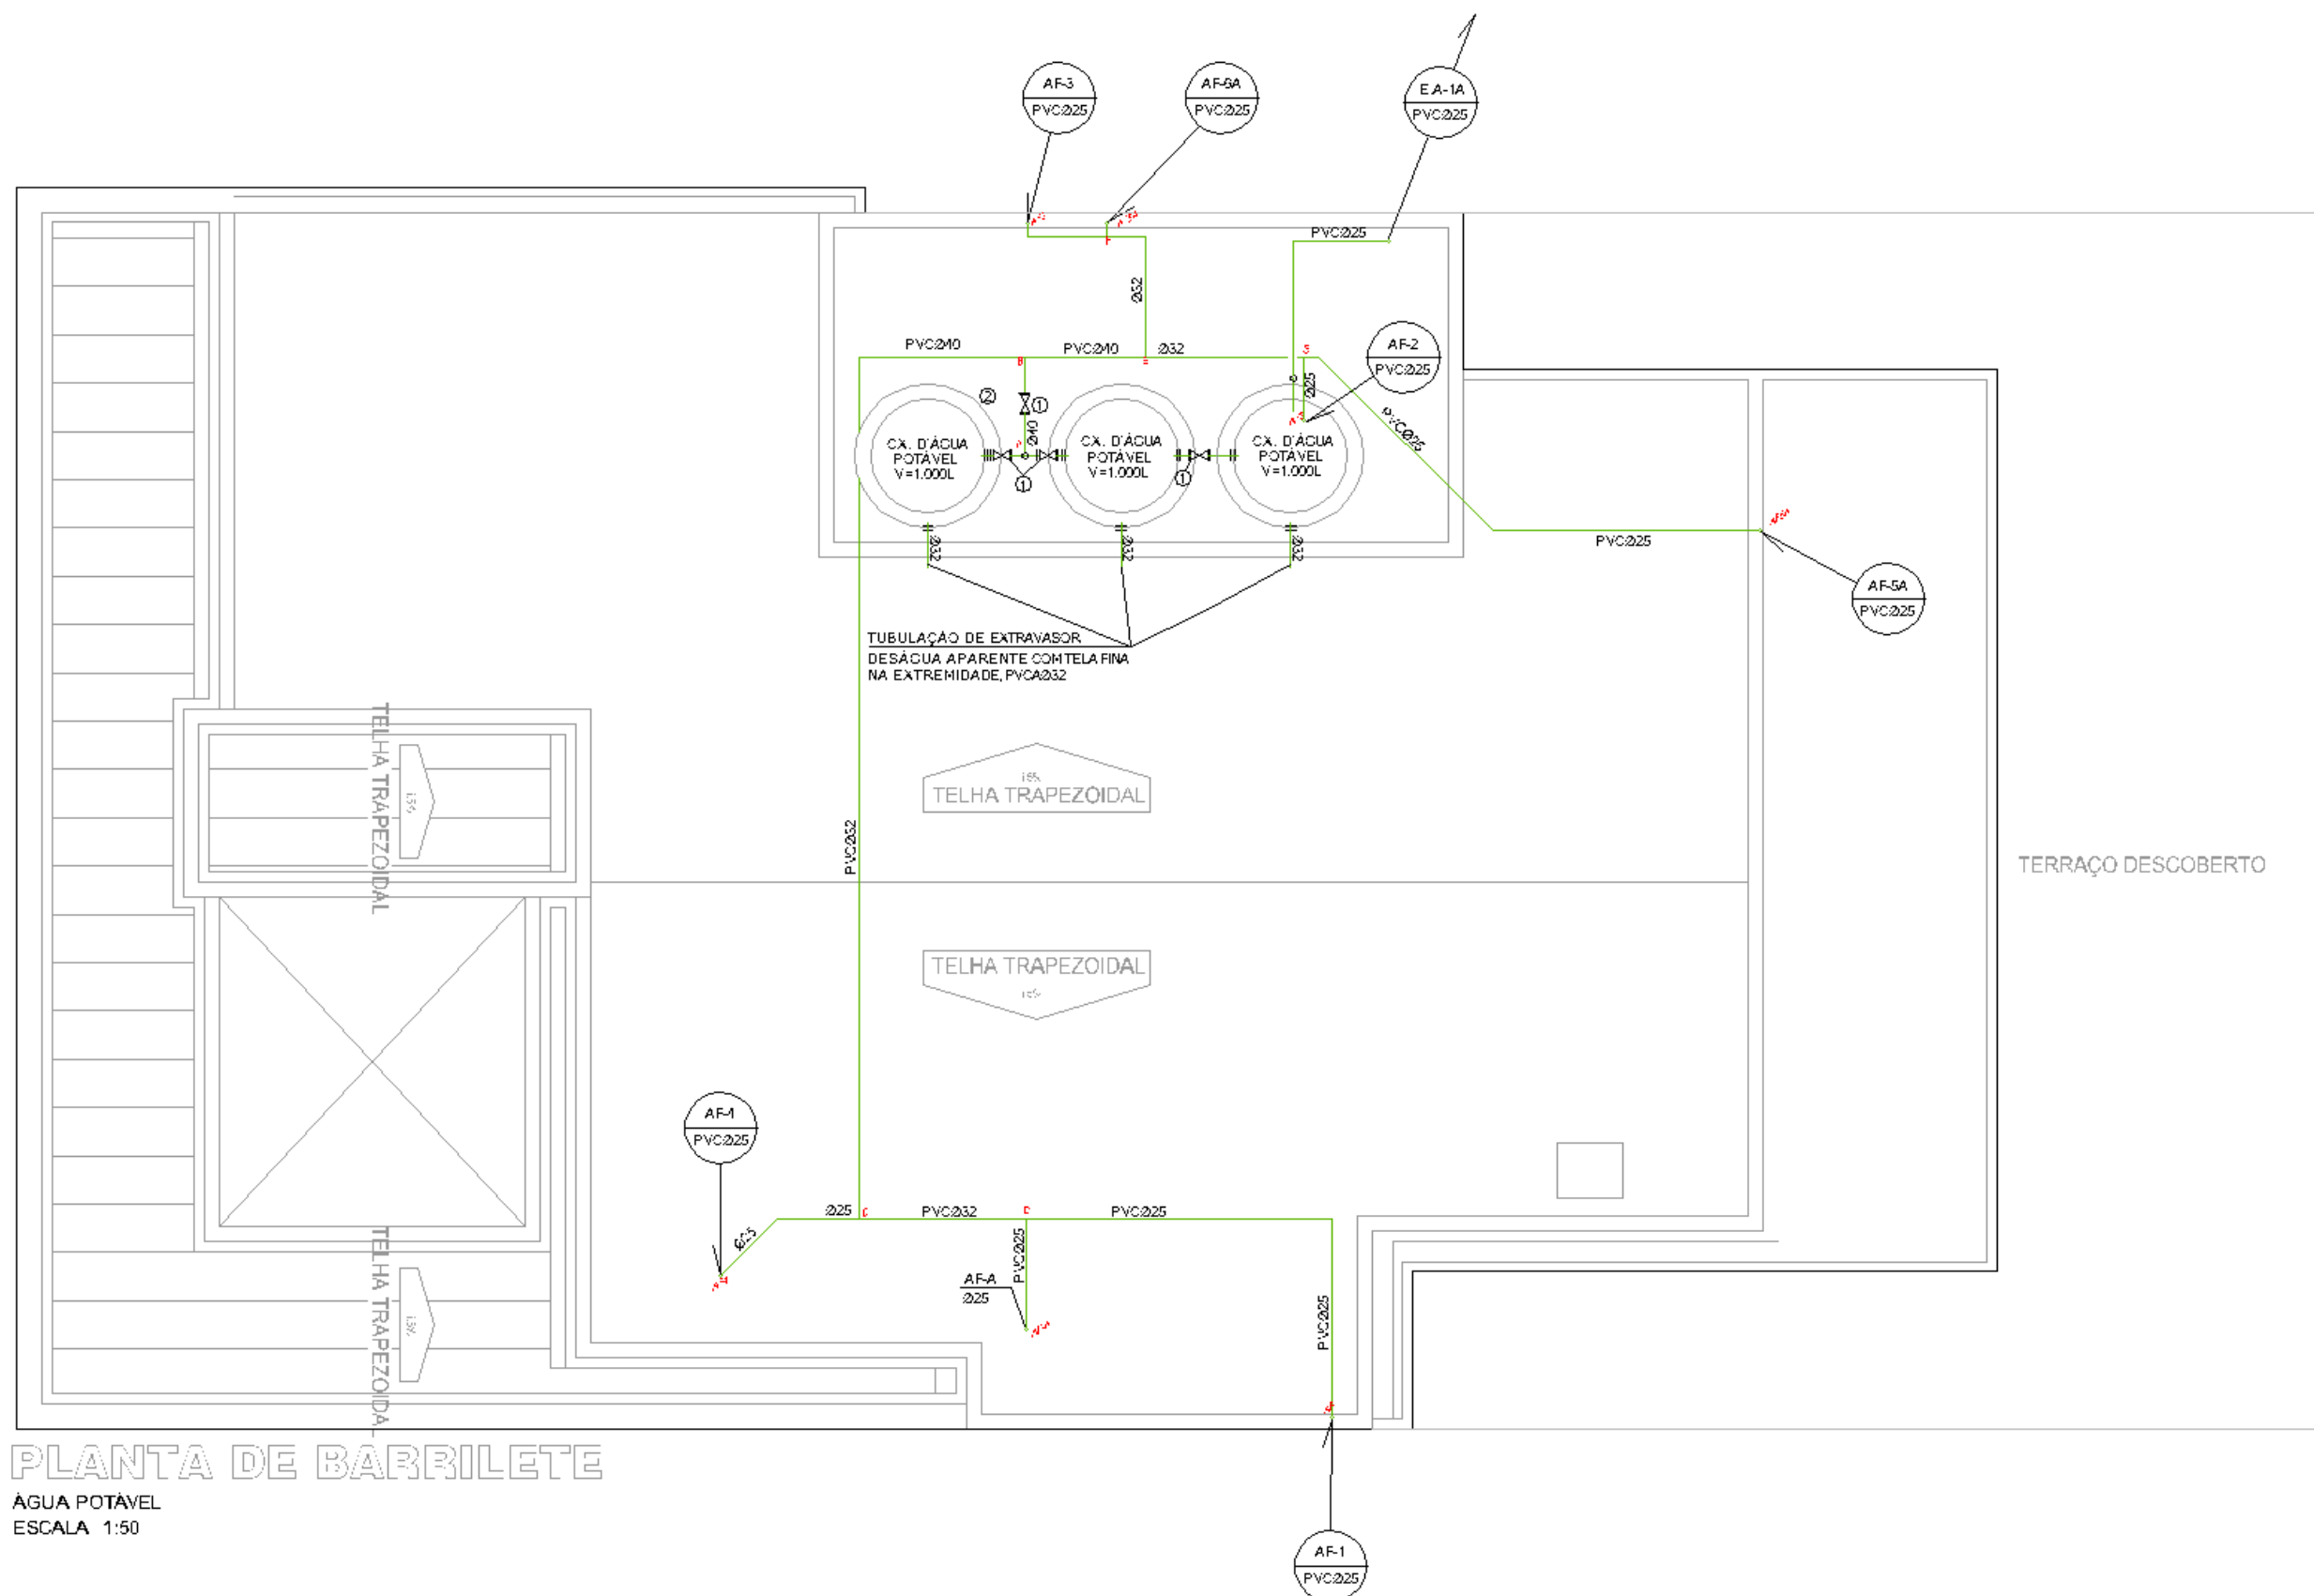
Planta de Barrilete Água fria. Fonte: Autor.
